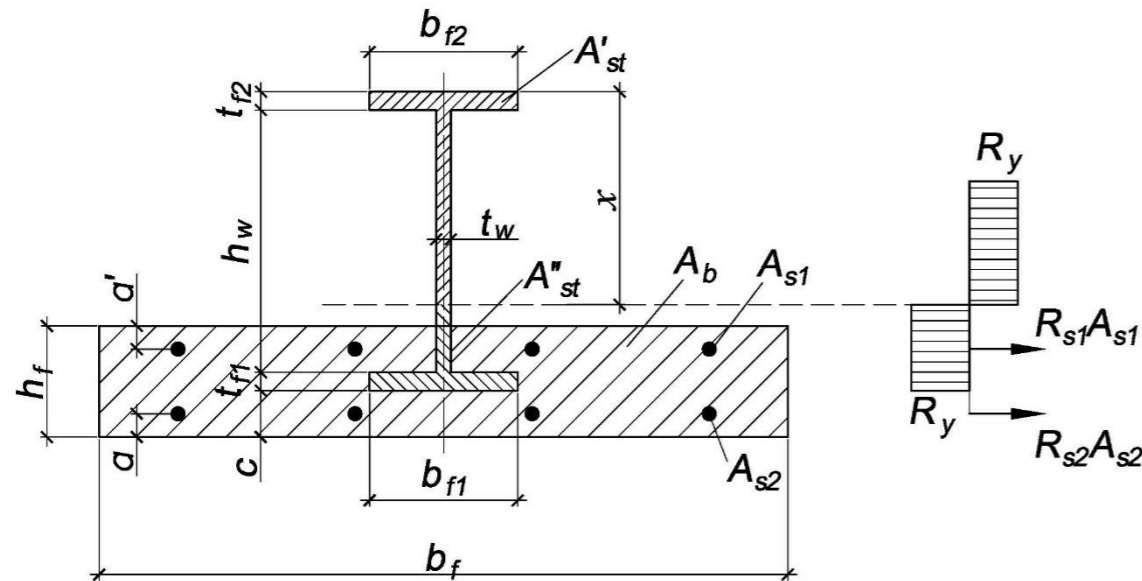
Случай, когда нейтральная ось пересекает стенку стального профиля жесткой арматуры в комбинированной балки с опиранием железобетонной плиты на нижний пояс
